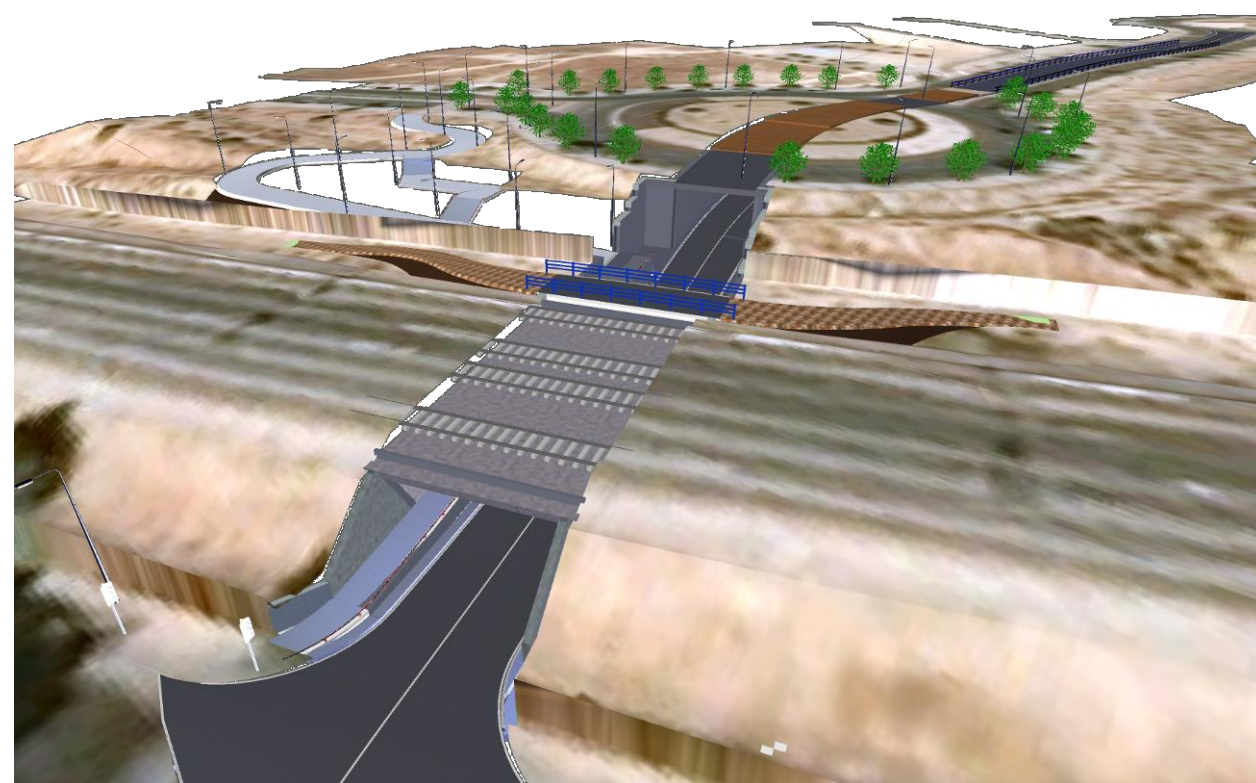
Vista del paso inferior bajo la plataforma ferroviaria.
